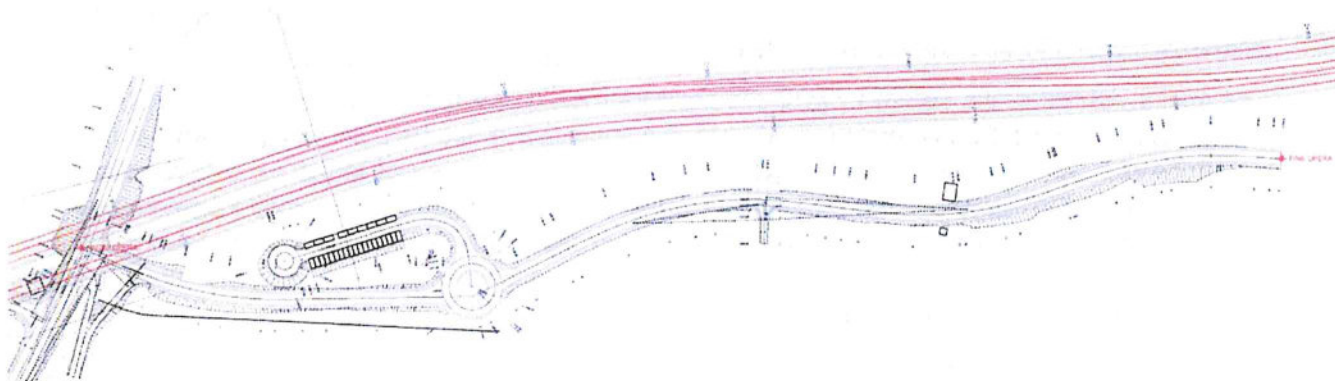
NV05 – Stralcio planimetrico su rilievo di Via L.Fava
